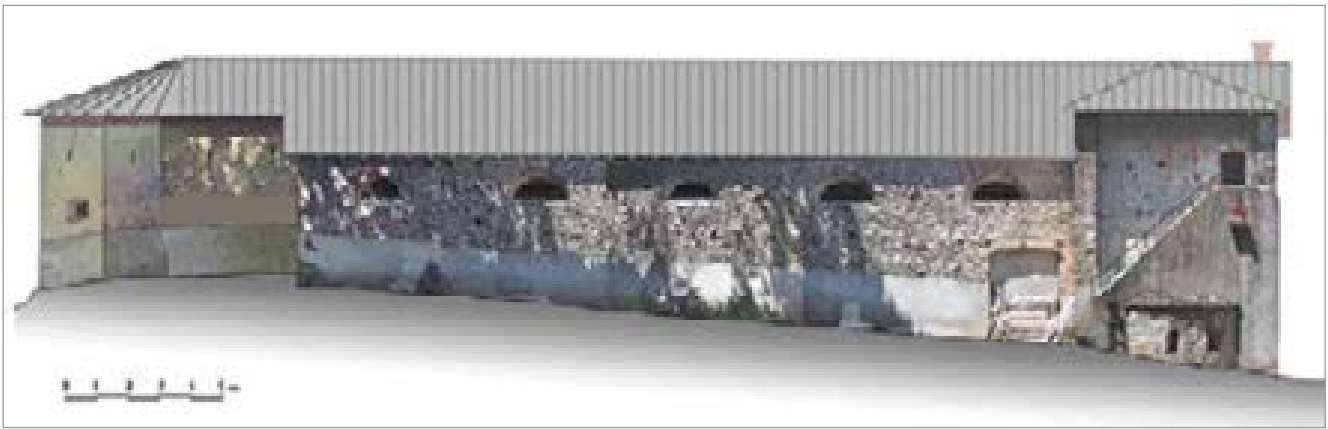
Prospetto di levante del complesso con fotoraddrizzamento (Bergamini, luglio 2015).
